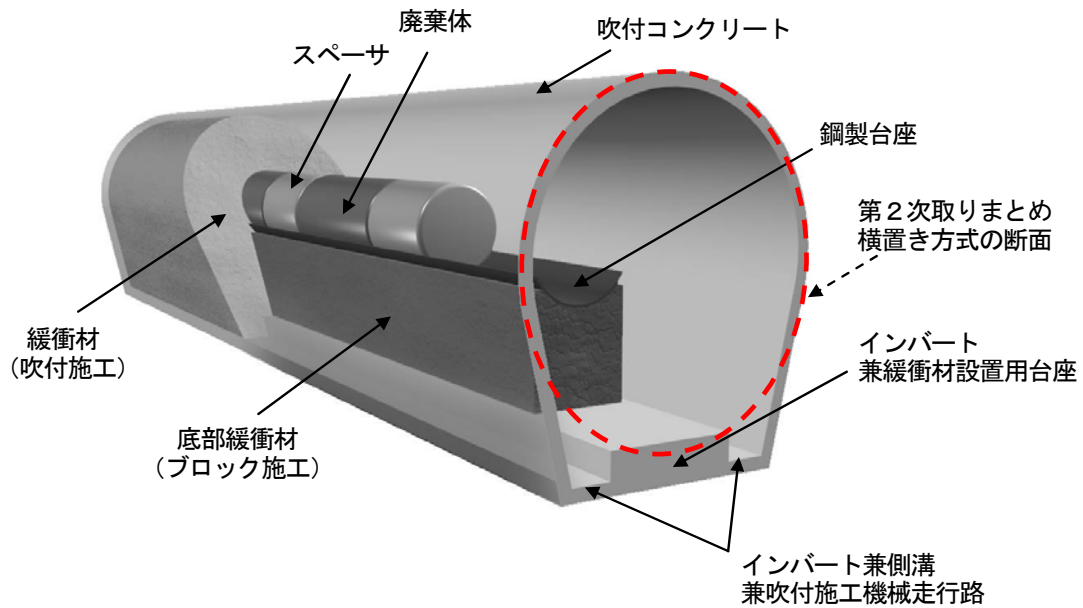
作業性を考慮した処分坑道横置き定置方式（原位置施工方式）
